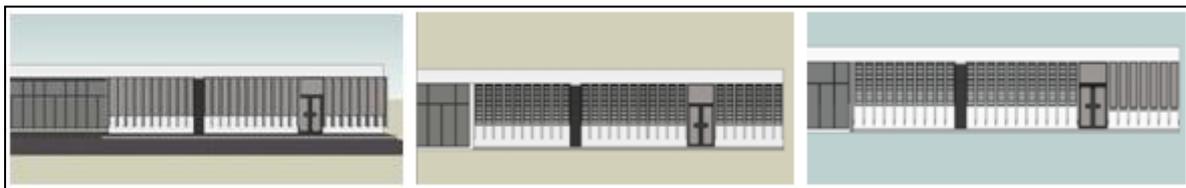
Propostas de Brises desenvolvidas para a Fachada Norte
